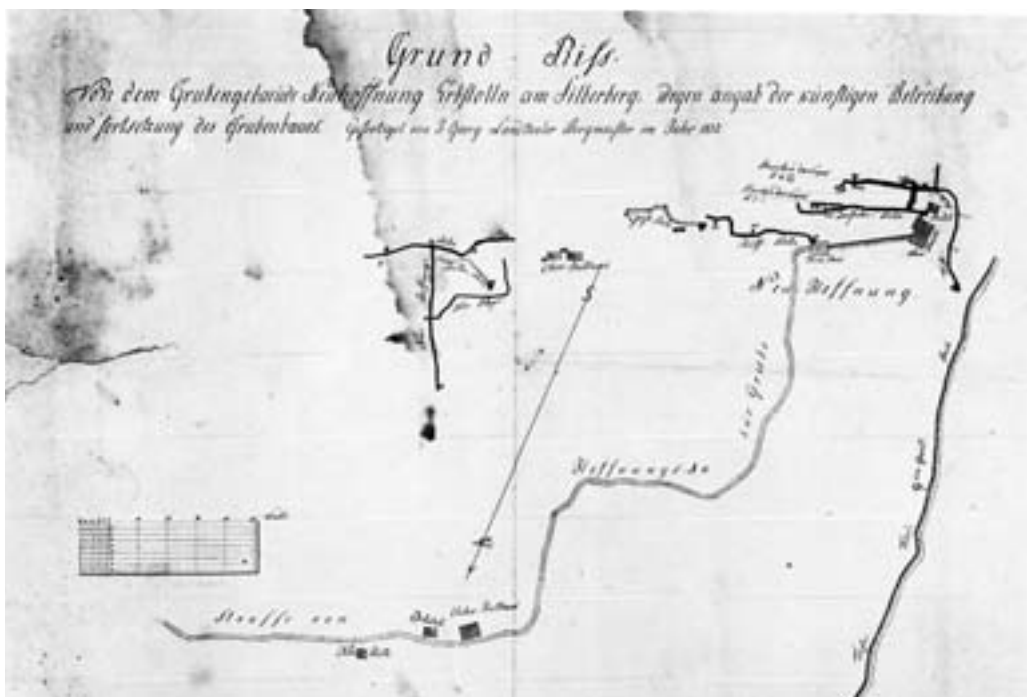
Grundriss von dem Grubengebäude Neuhoftungs-Erbstollen am Silberberg... gefertigt von J. Georg Landthaler, Bergmeister im Jahr 1812.
